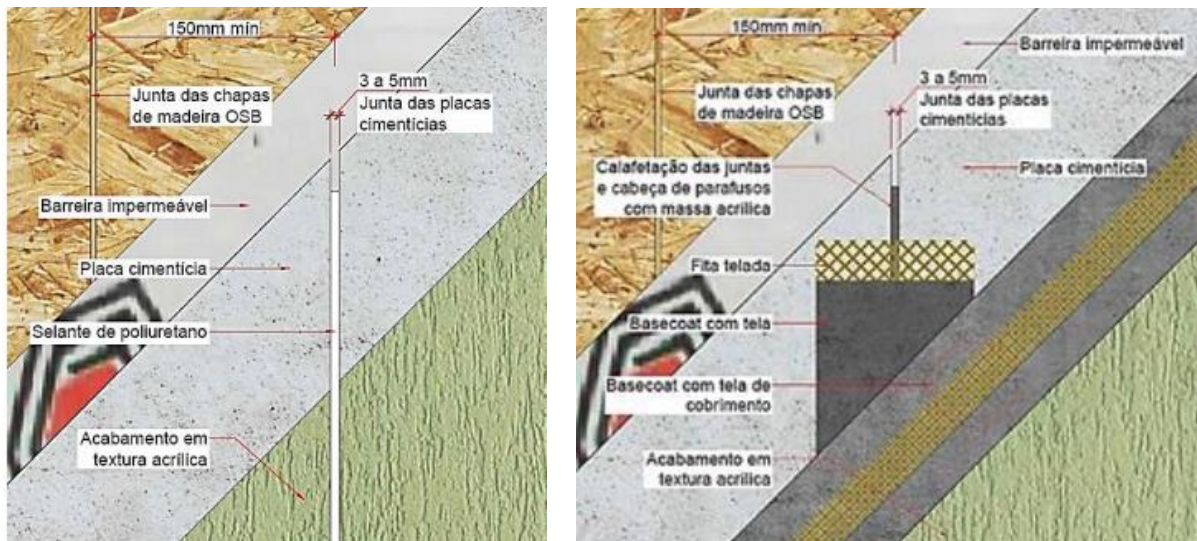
Detalhe da junta aparente e da junta dissimulada [27]
